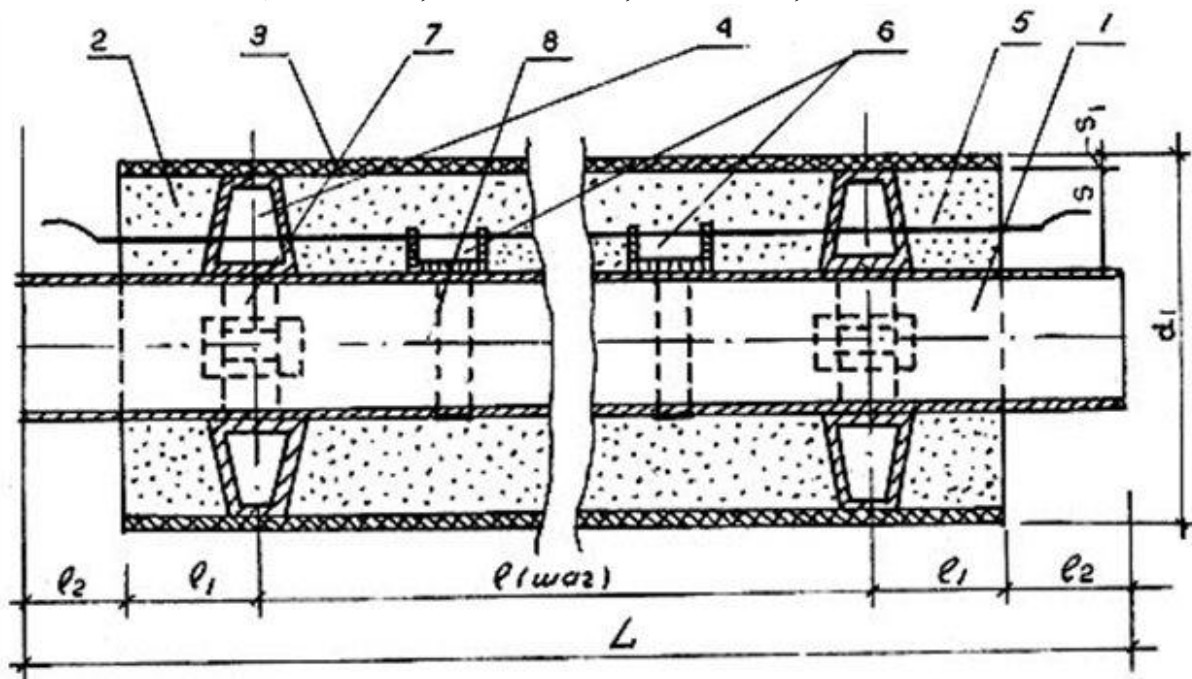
Индустриальная конструкция теплоизоляции труб:
